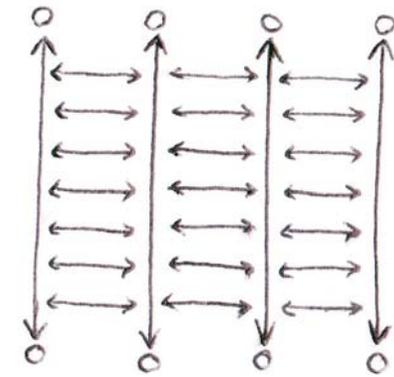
Statisches Prinzip im Ausstellungstrakt. Linear addierte Hauptträger mit orthogonalen Nebenträger.
